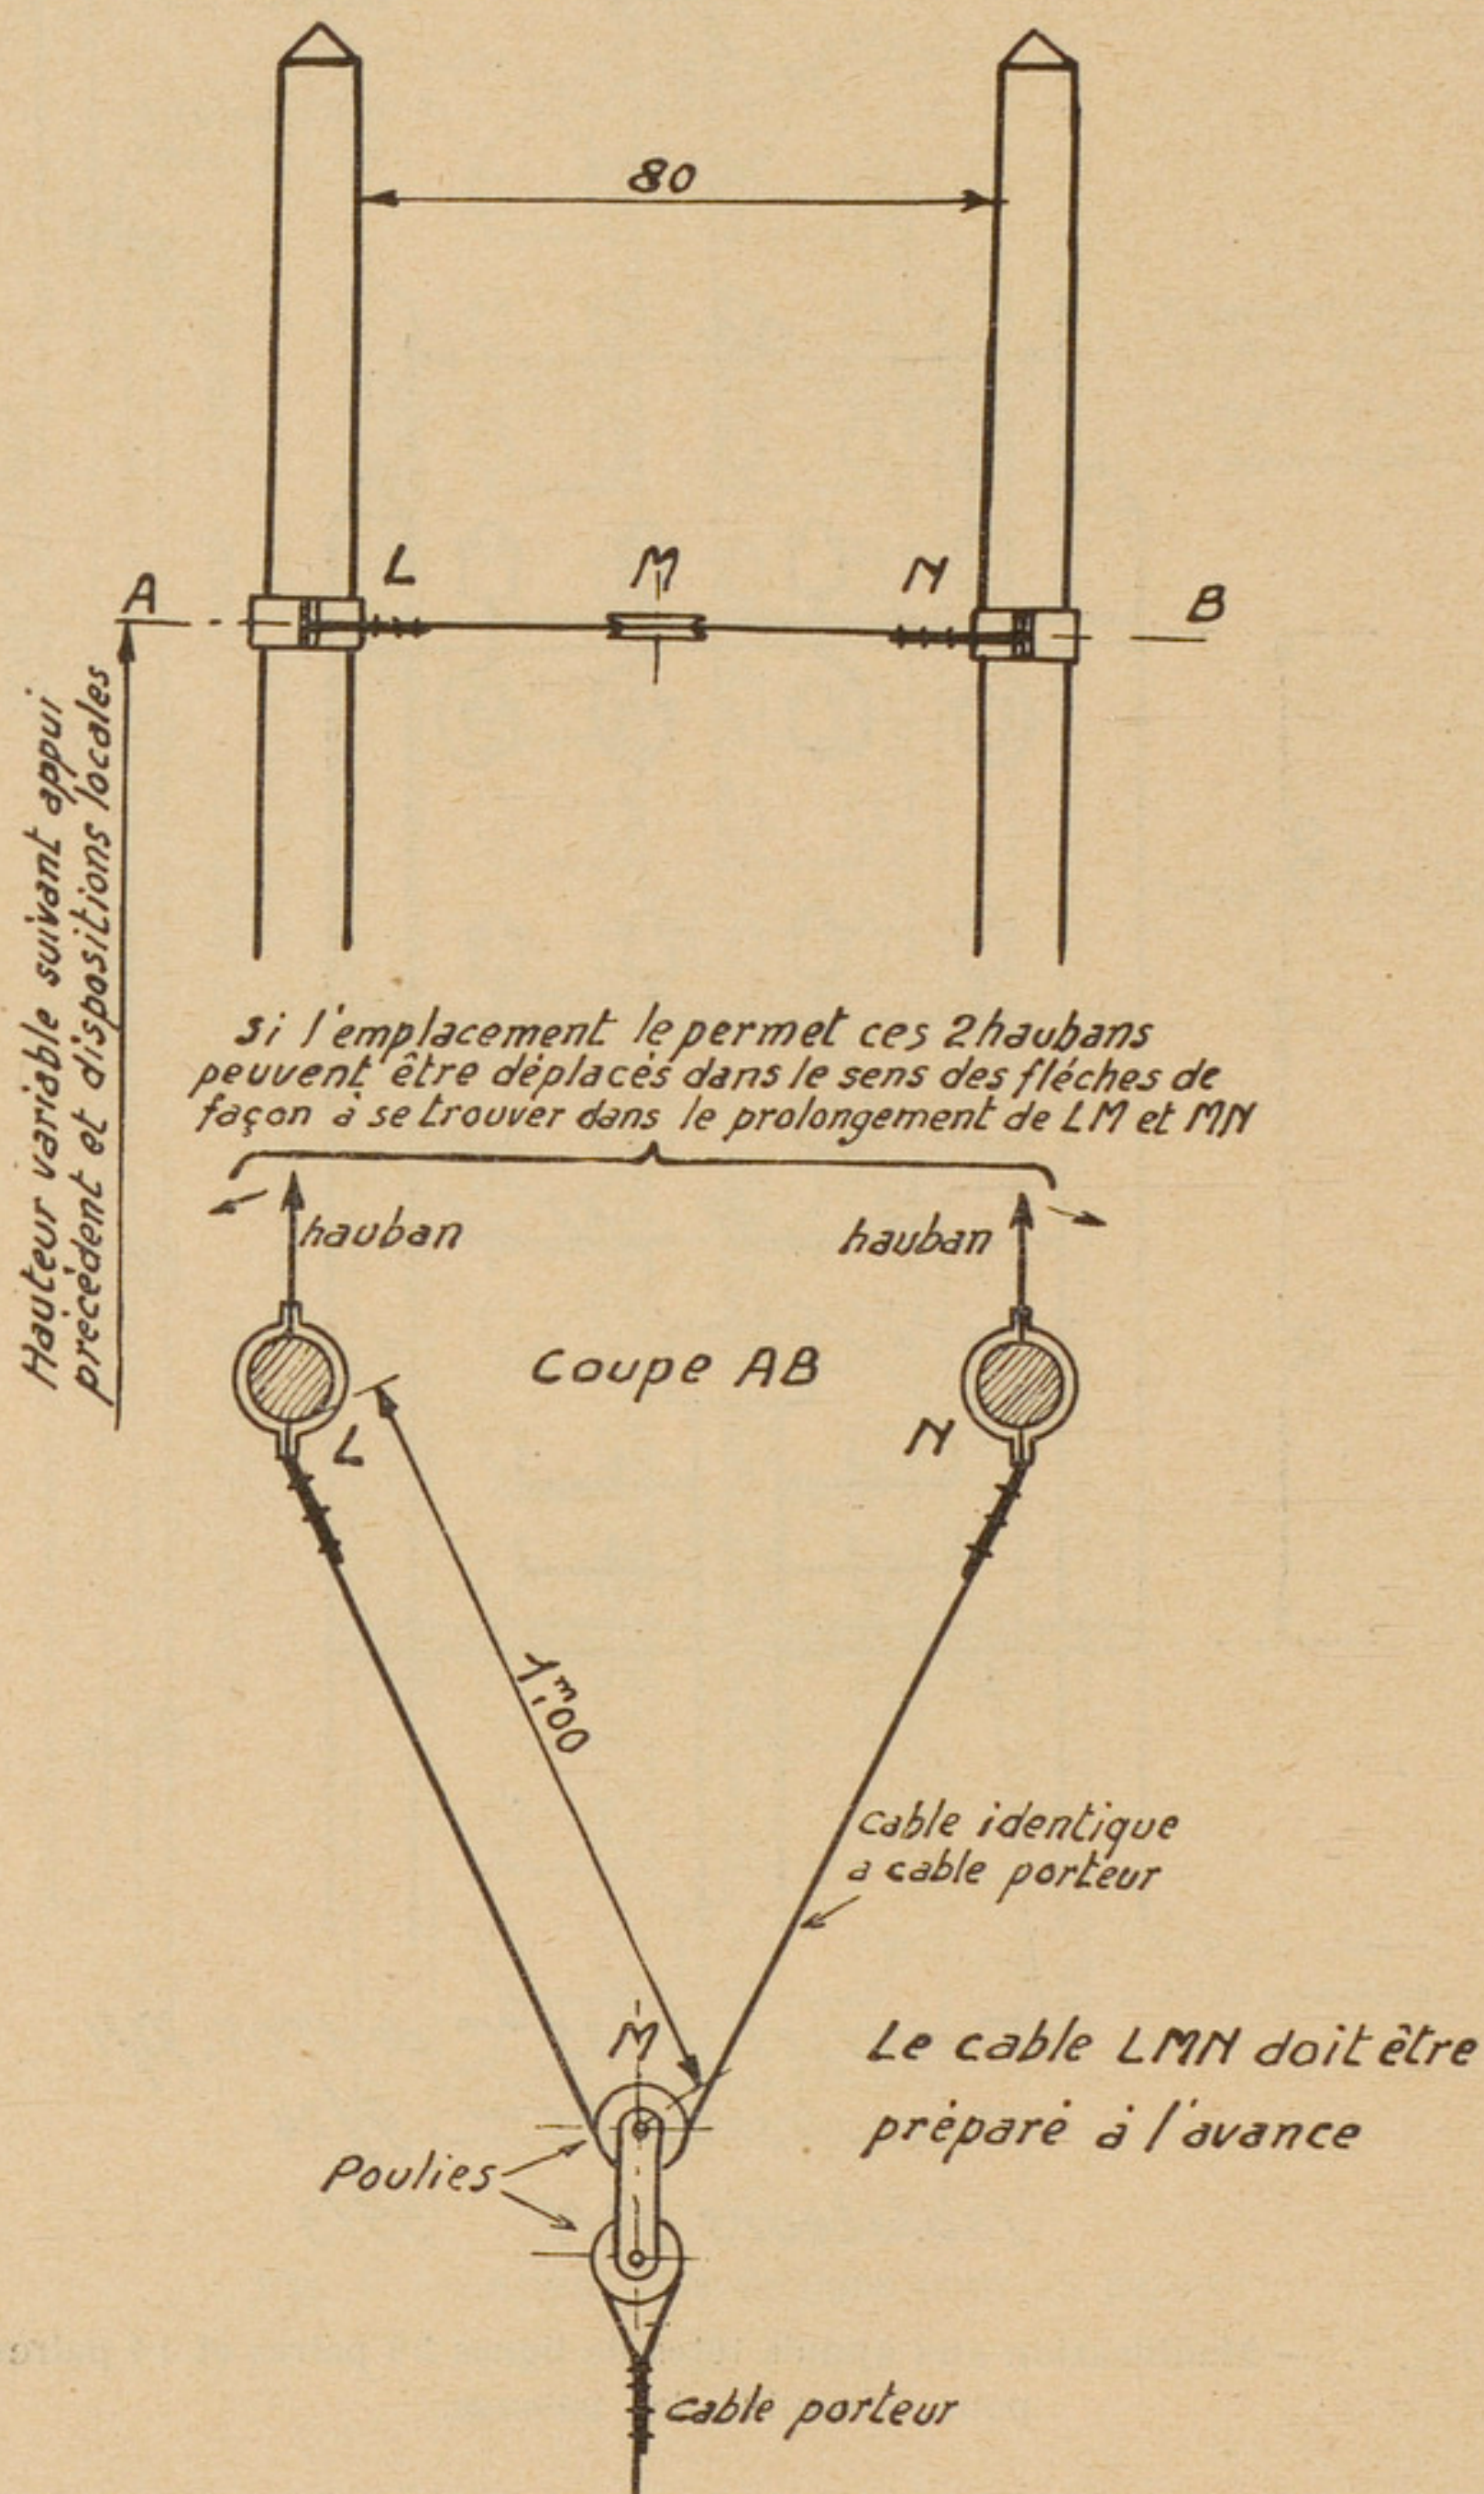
Fixation du câble porteur sur les appuis têtes de lignes sur poteaux.
